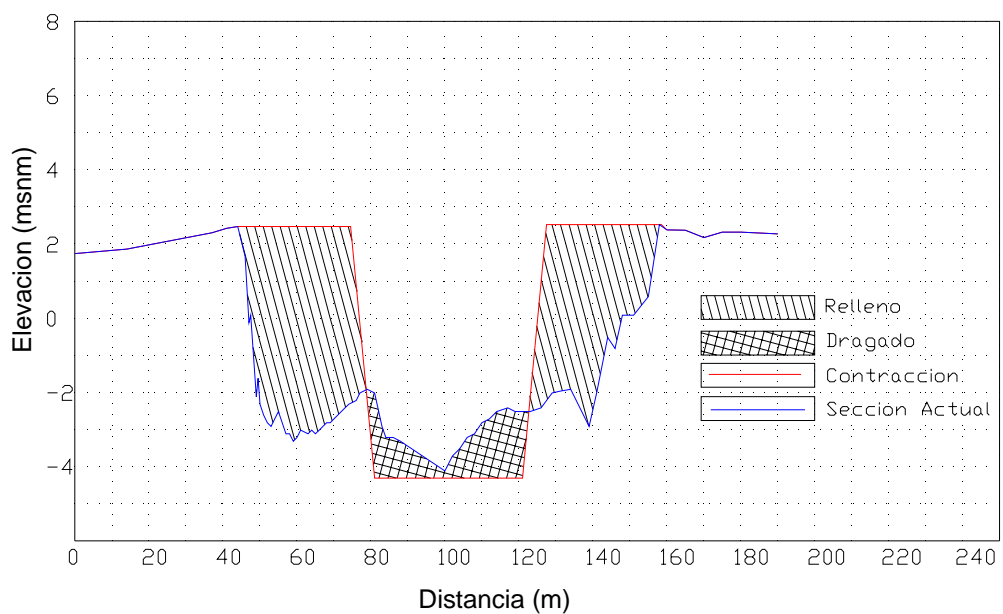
Sección transversal km 75 - Contracción No. 3
